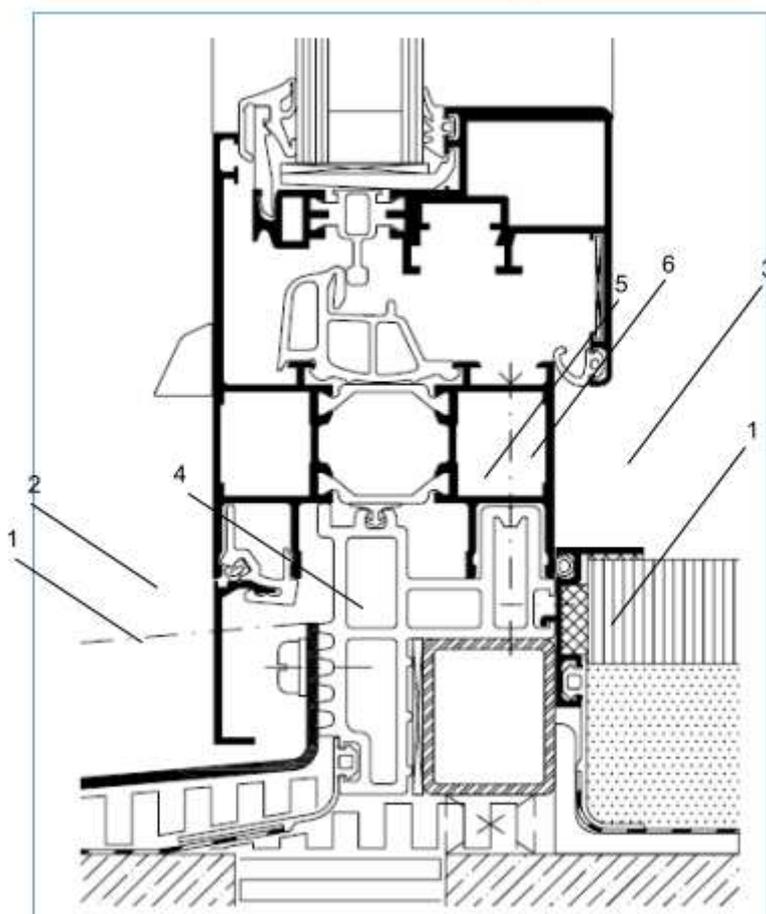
Exemples de fixation du seuil extérieur et intérieur à la fenêtre en profilés aluminium.
